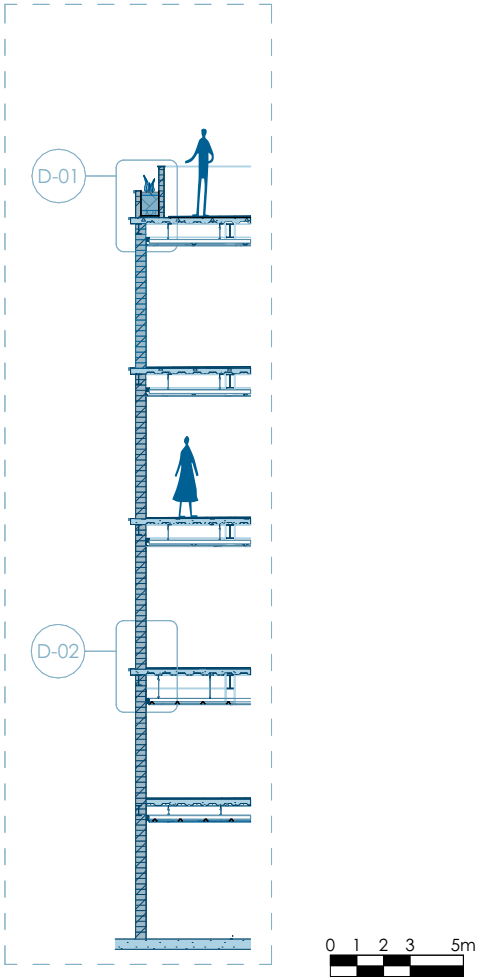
Sección constructiva A. Nota. Elaboración propia.
